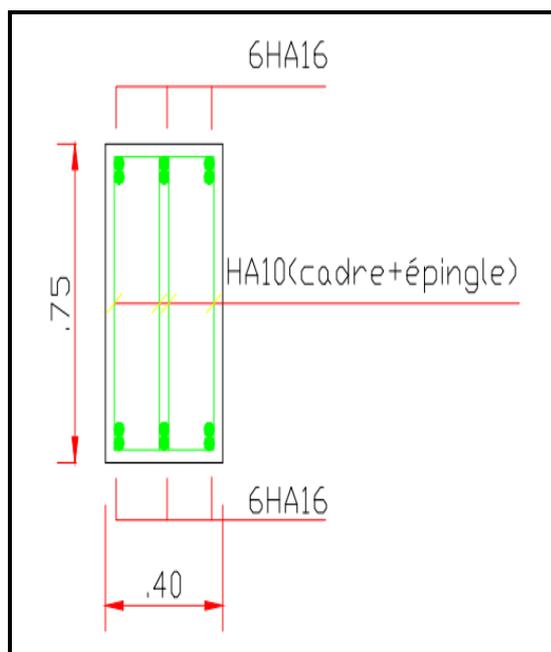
ferrailage coupe en travée selon x-x et y-y.
